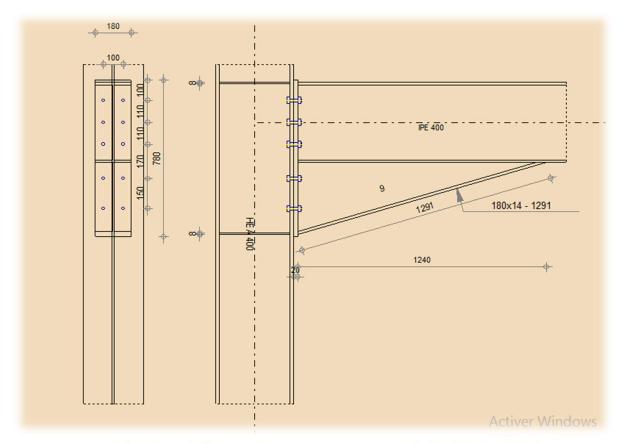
Détail d'assemblage poteau - poutre (HEA400-IPE400)
